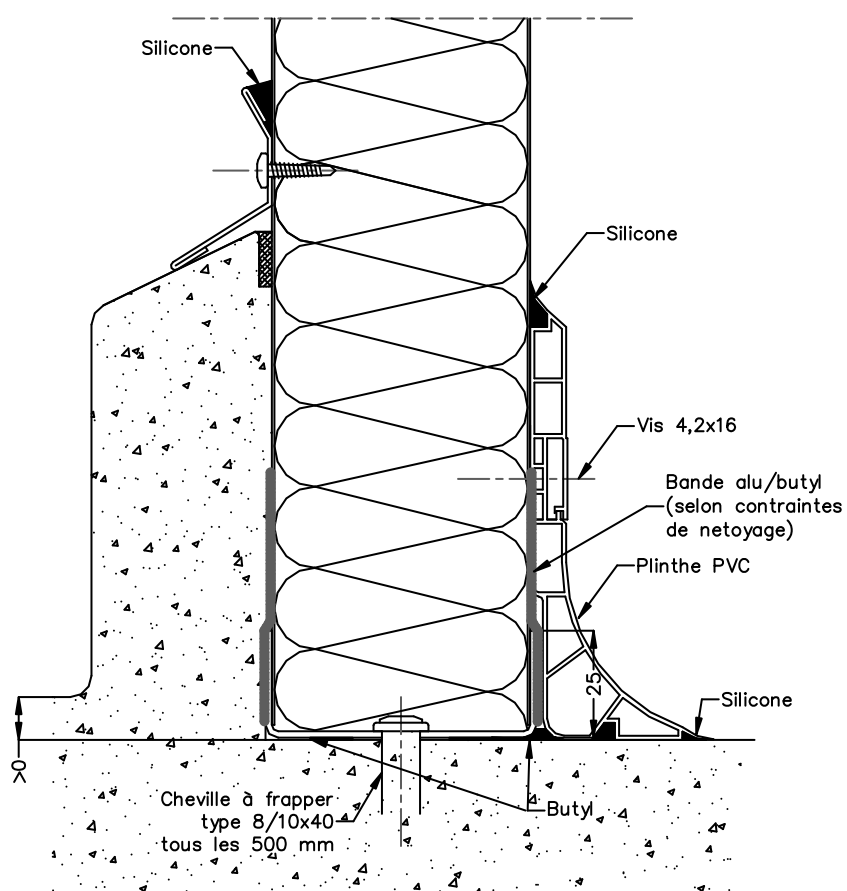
Schéma 2 – Panneaux liaison au sol – Banquette béton / Plinthe PVC
